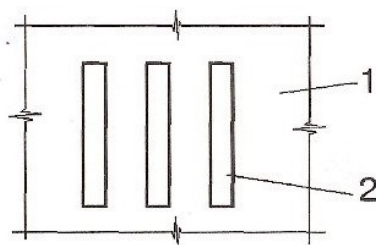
Посилення залізобетонної плити приклеюванням зовнішньої арматури:
